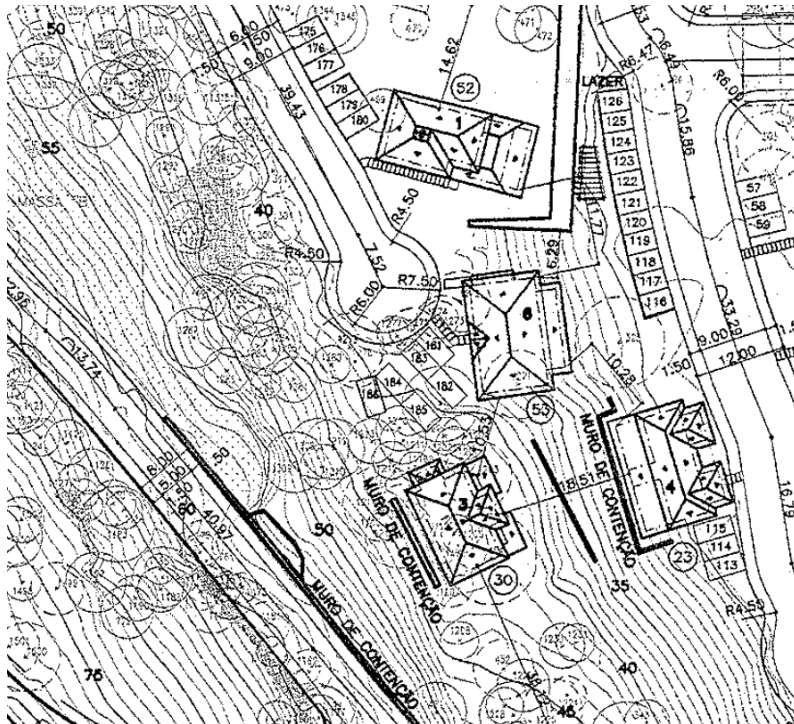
Detalhe da Planta de Situação Geral – modificação de projeto aprovado na SMU (fls 937)
